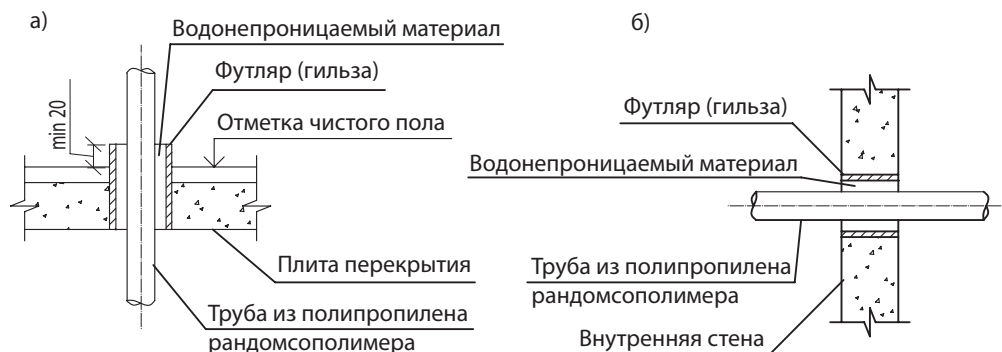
Установка футляров для прохода напорных труб из полипропилена рандомсополимера через строительные конструкции
